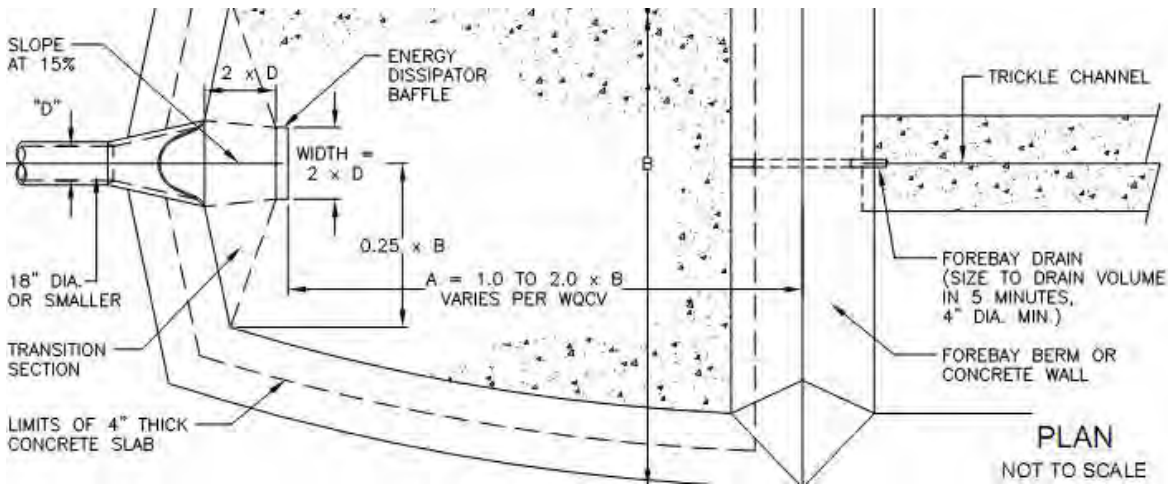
Vista en planta de la obra de toma de disipación de energía propuesta
